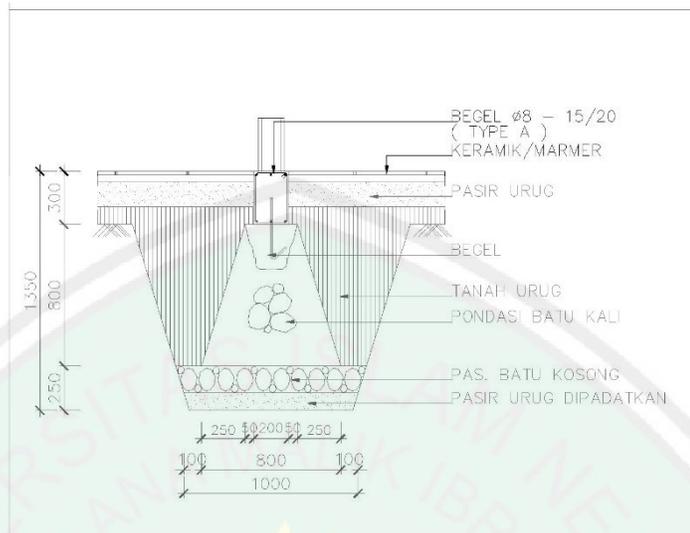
Rencana Pondasi Kantor Pengelola dan Musholla
